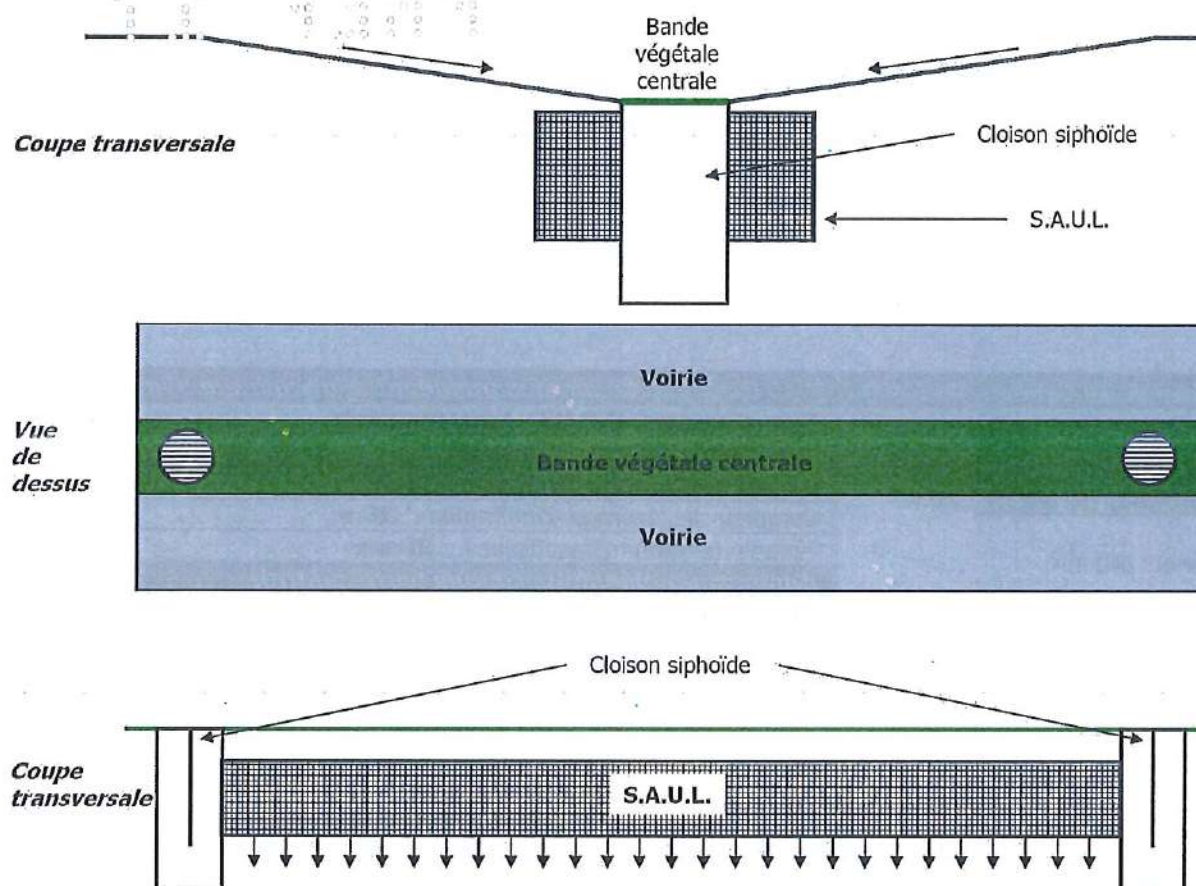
coupe de principe d'une voie avec tranchée d'infiltration sous bande verte centrale
